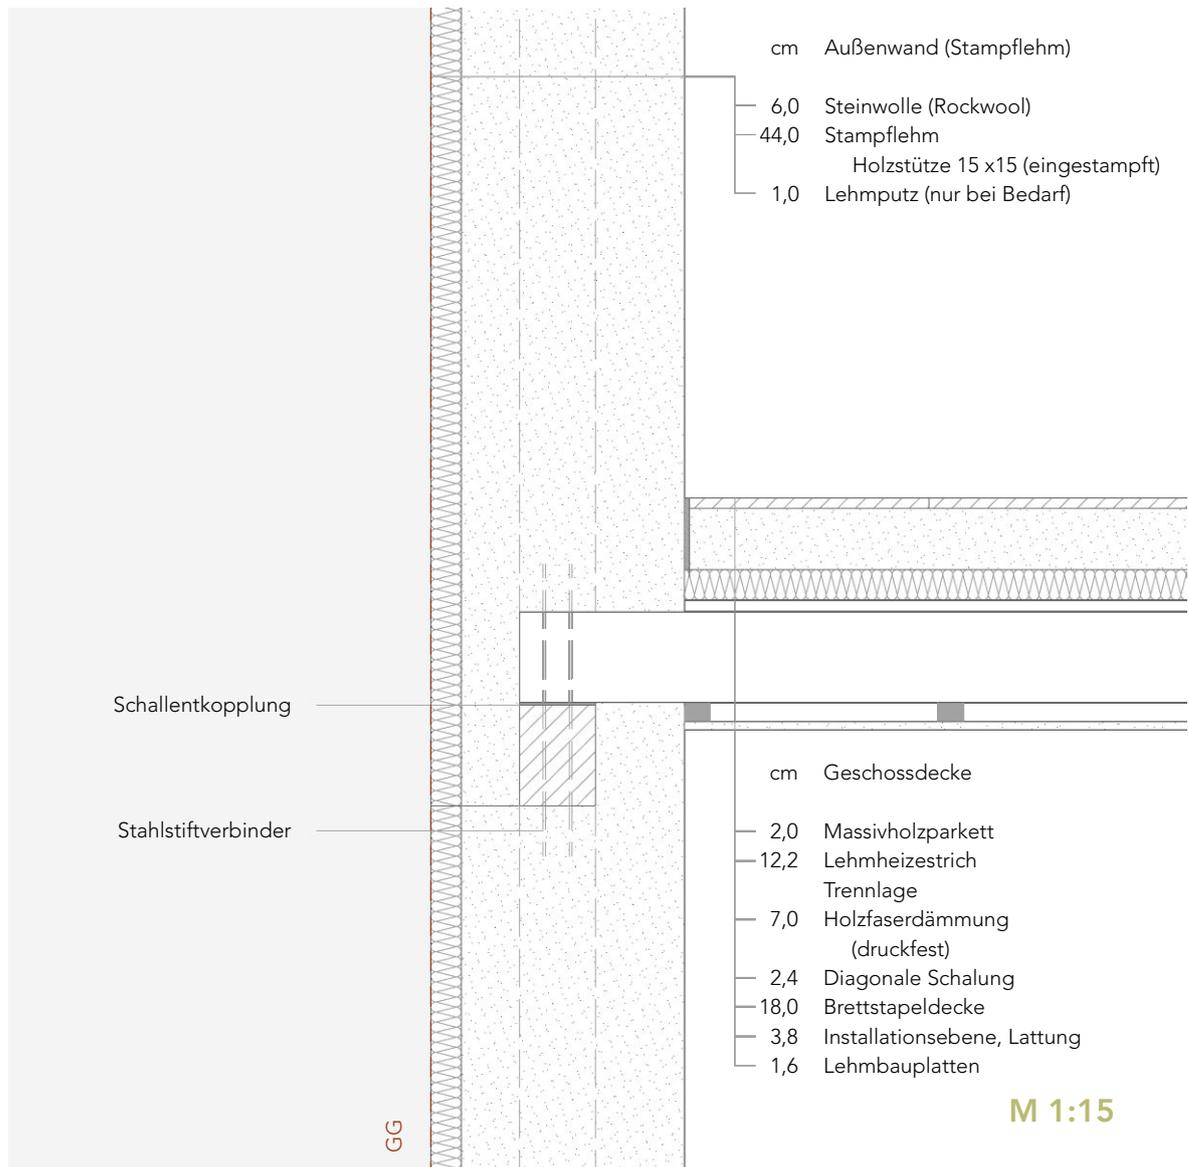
Anschlussdetail Holzdecke-Lehmwand
